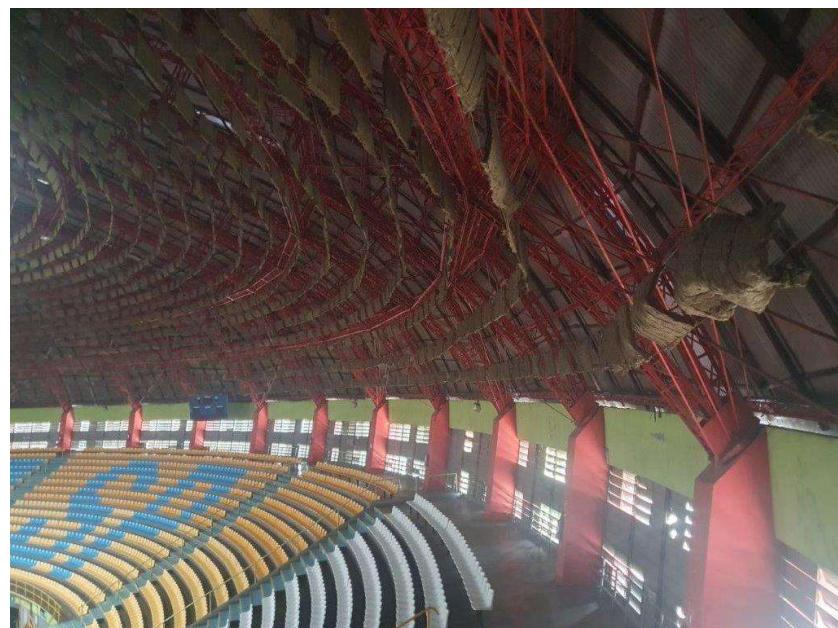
Transição entre os apoios perimetrais em concreto e as nervuras treliçadas (Iphan)
